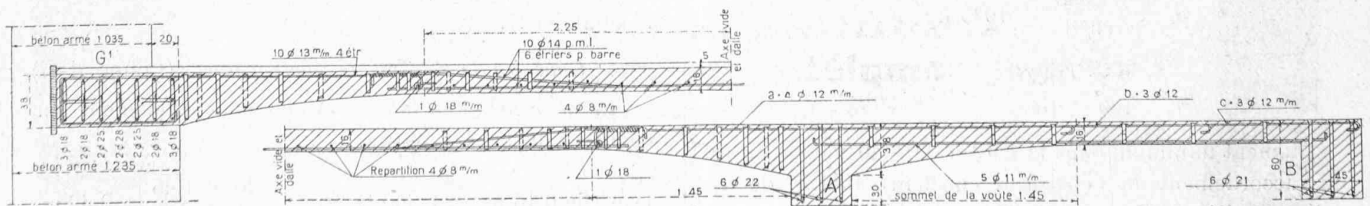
Armatures de la poutraison sur le rez-de-chaussée. — Demi-coupe C-D.
